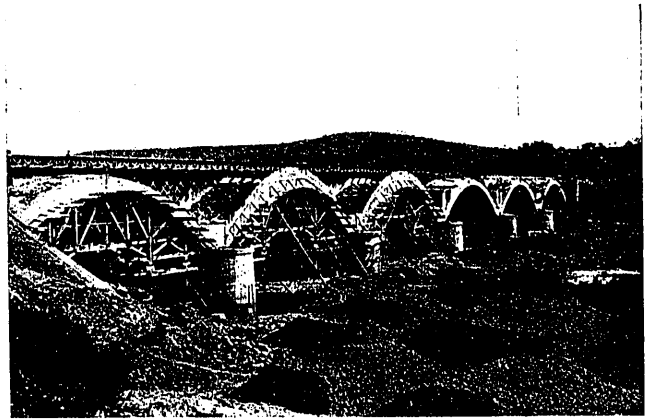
ª La primera mitad del puente en construcción (29 mayo 1927).
